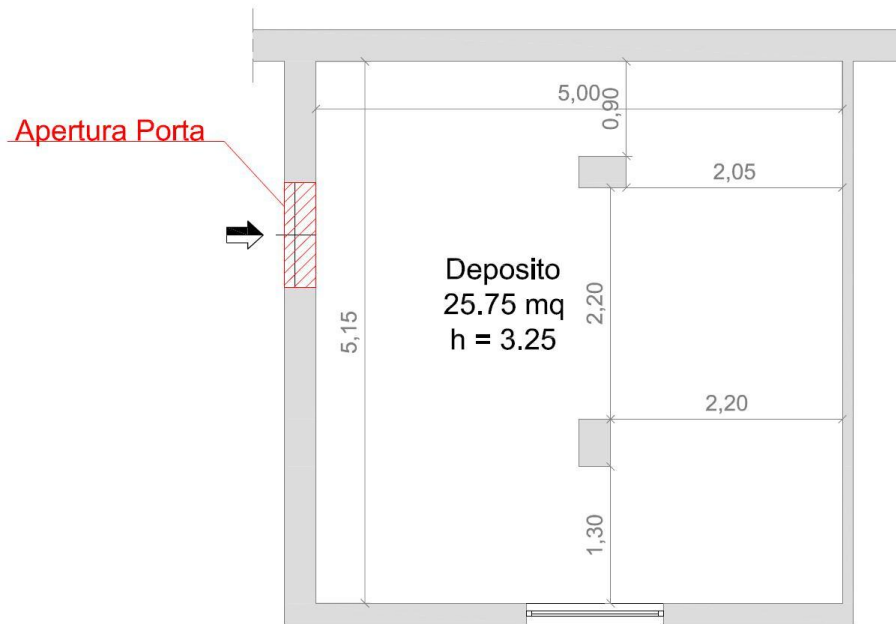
Planimetria Stato di fatto Foglio 46, p.lla 1235, sub 17.
